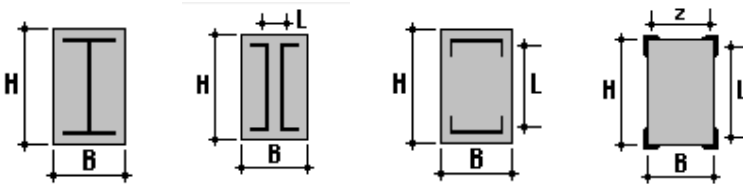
Типы поперечных сечений сталебетонных конструкций для расчета в ЭСПРИ
